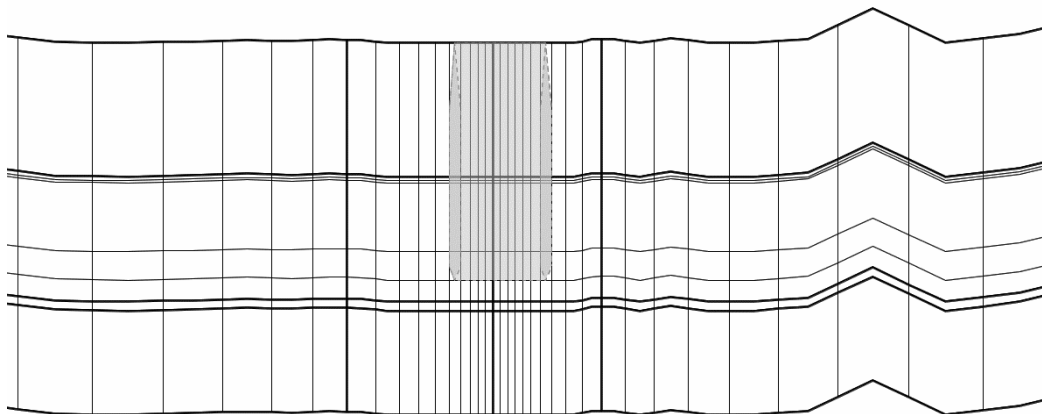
Muro pantalla de la obra en vista lateral del modelo. Fuente: Elaboración propia.
